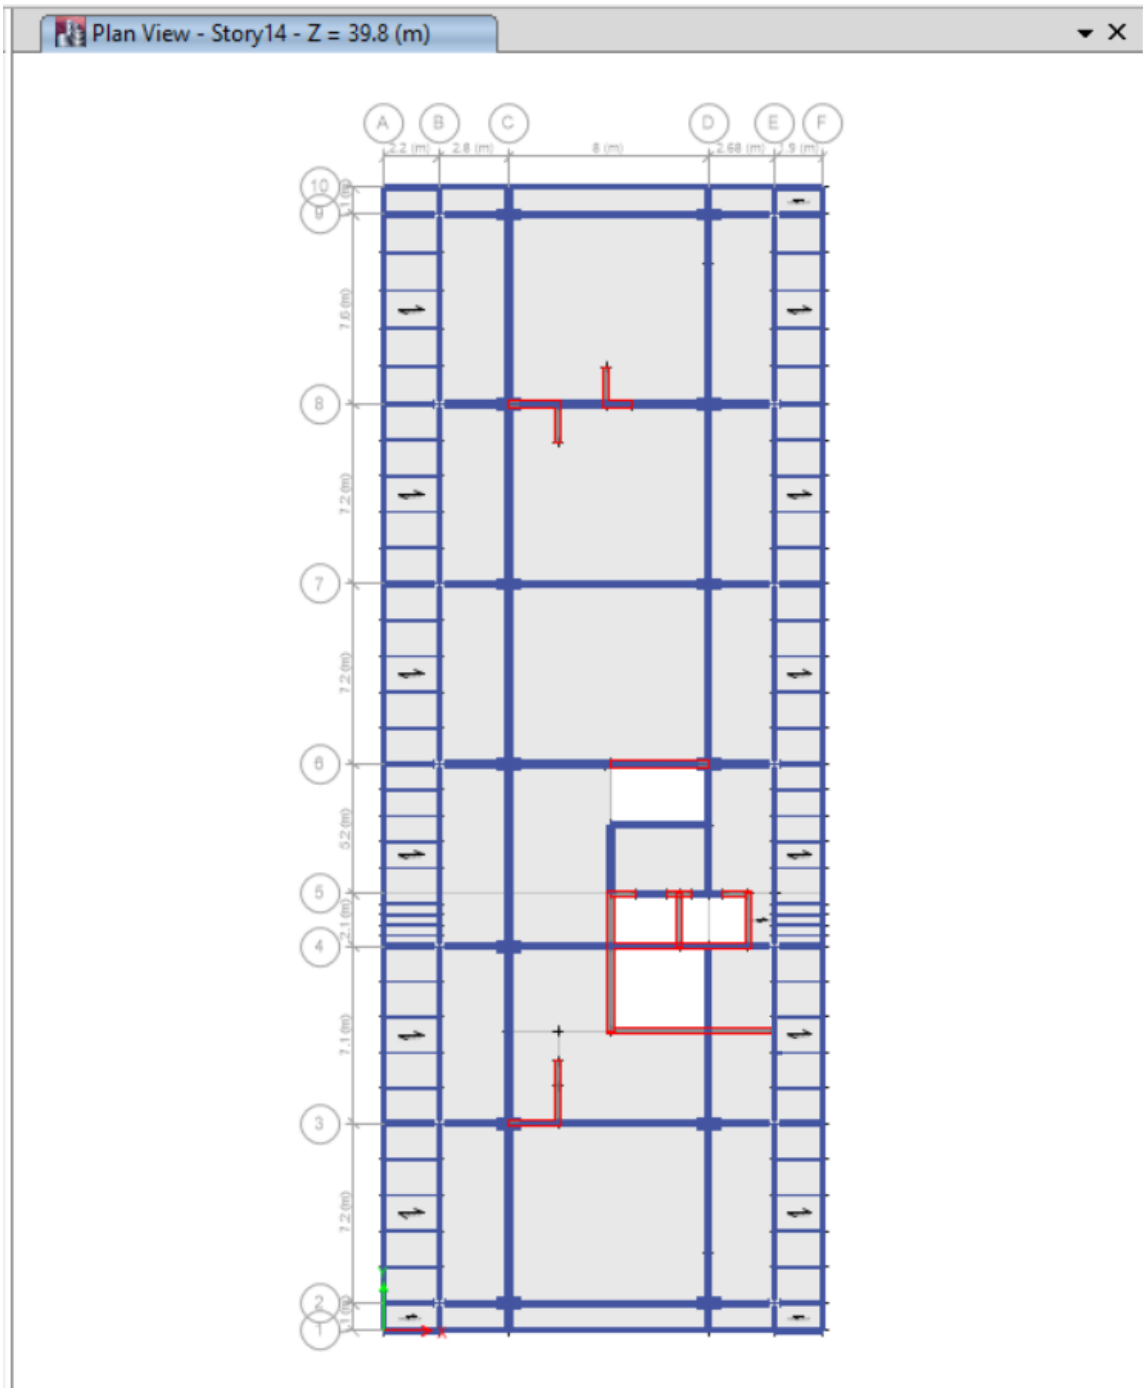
Planta de estructura modelada (en rojo se aprecian las placas de concreto armado propuestas como refuerzo, mientras que en azul a los extremos, se propone una estructura externa de acero).
